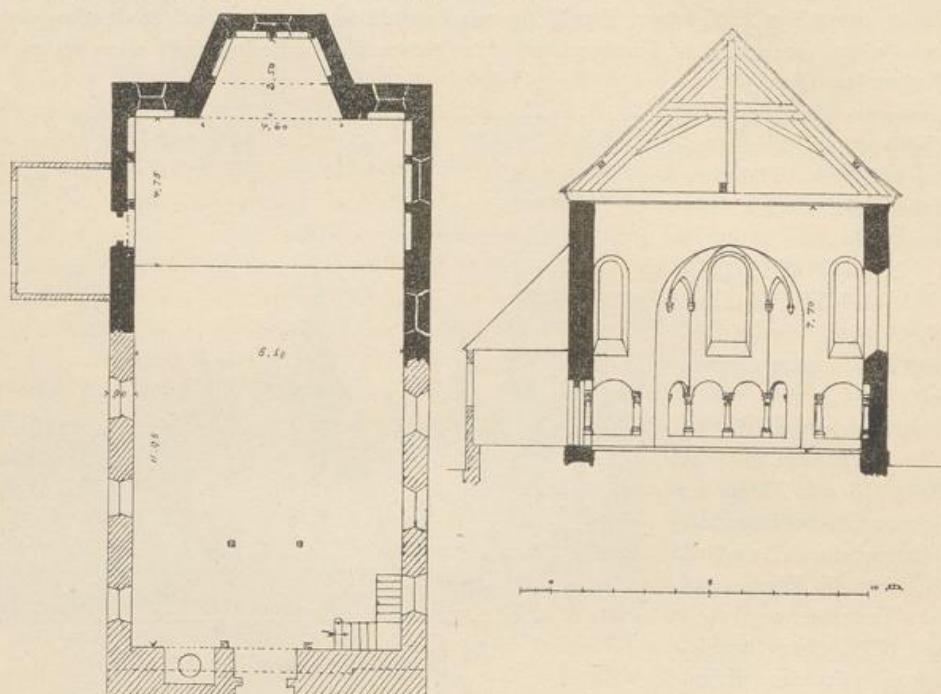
Burg. Grundriss und Querschnitt der katholischen Pfarrkirche.
